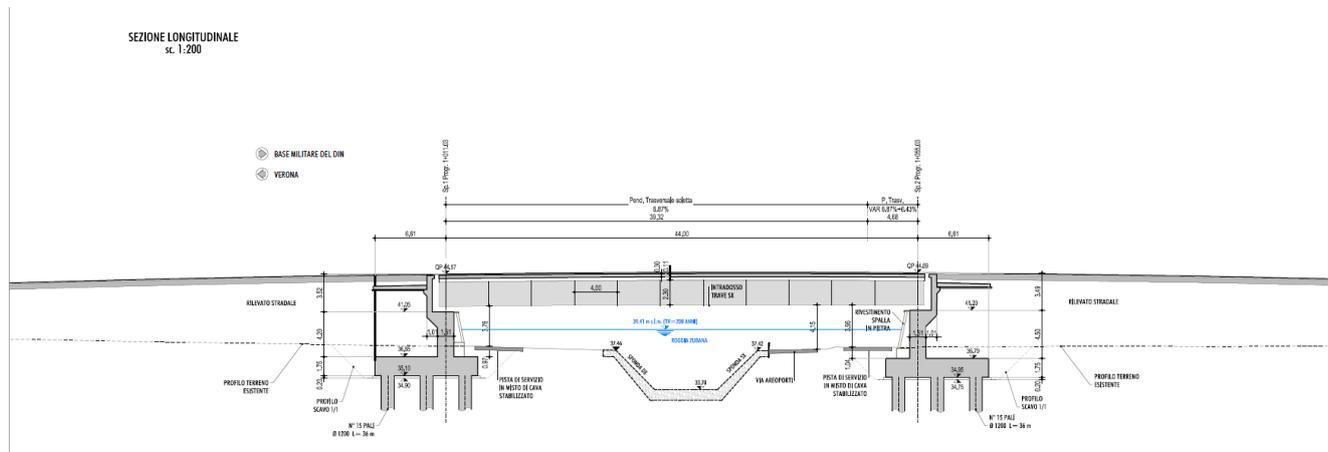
SEZIONE LONGITUDINALE DEL PONTE
